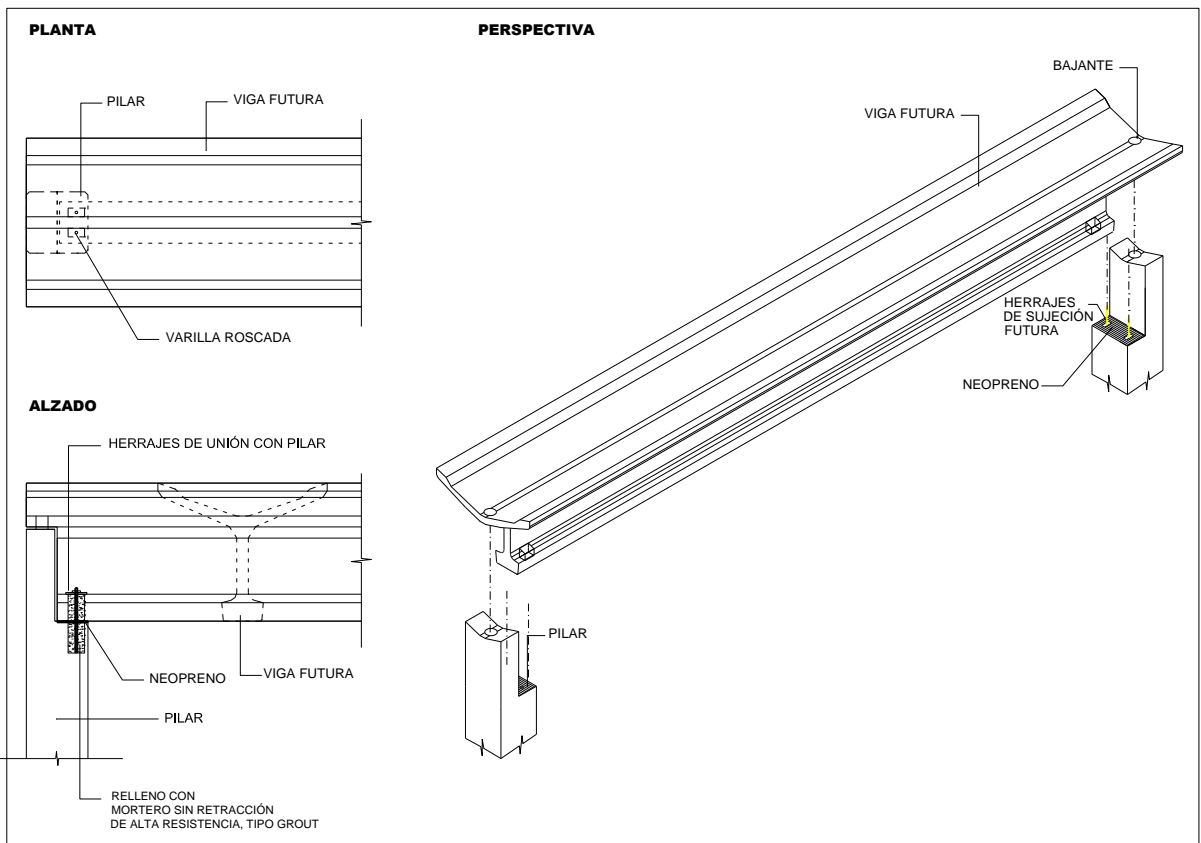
Unión pilar - viga FUTURA para zona sísmica
